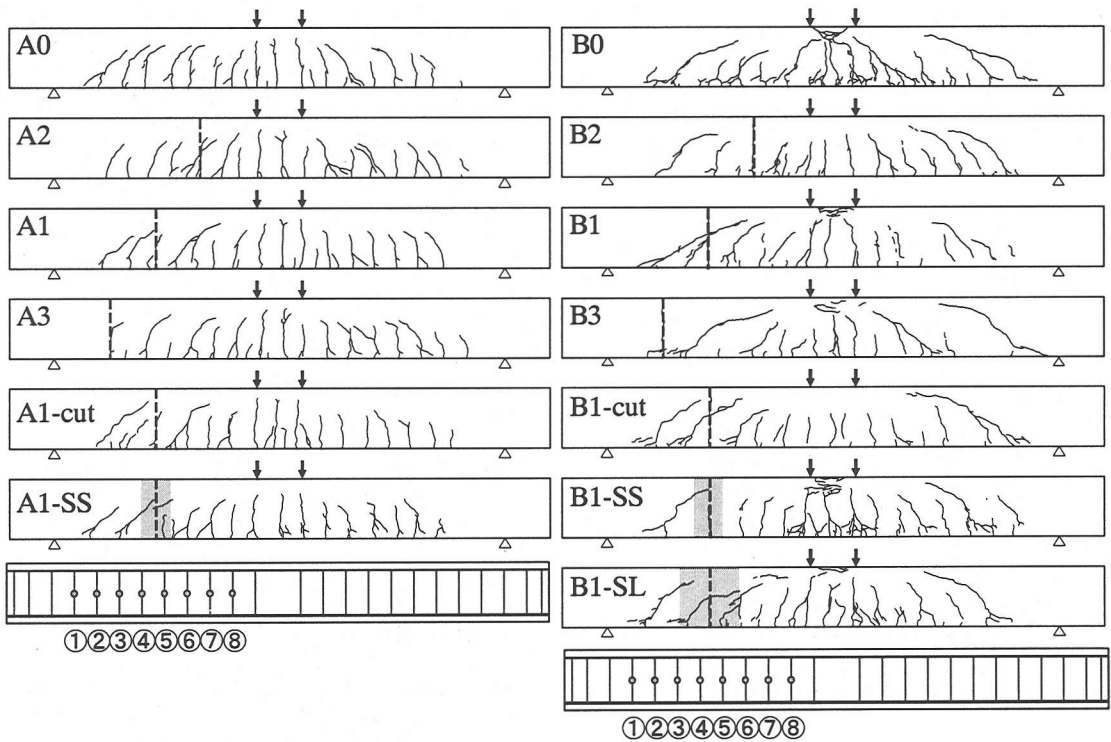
大型RCはりのひび割れ発生状況（破線は打継目位置，網掛けは鋼板被覆）
